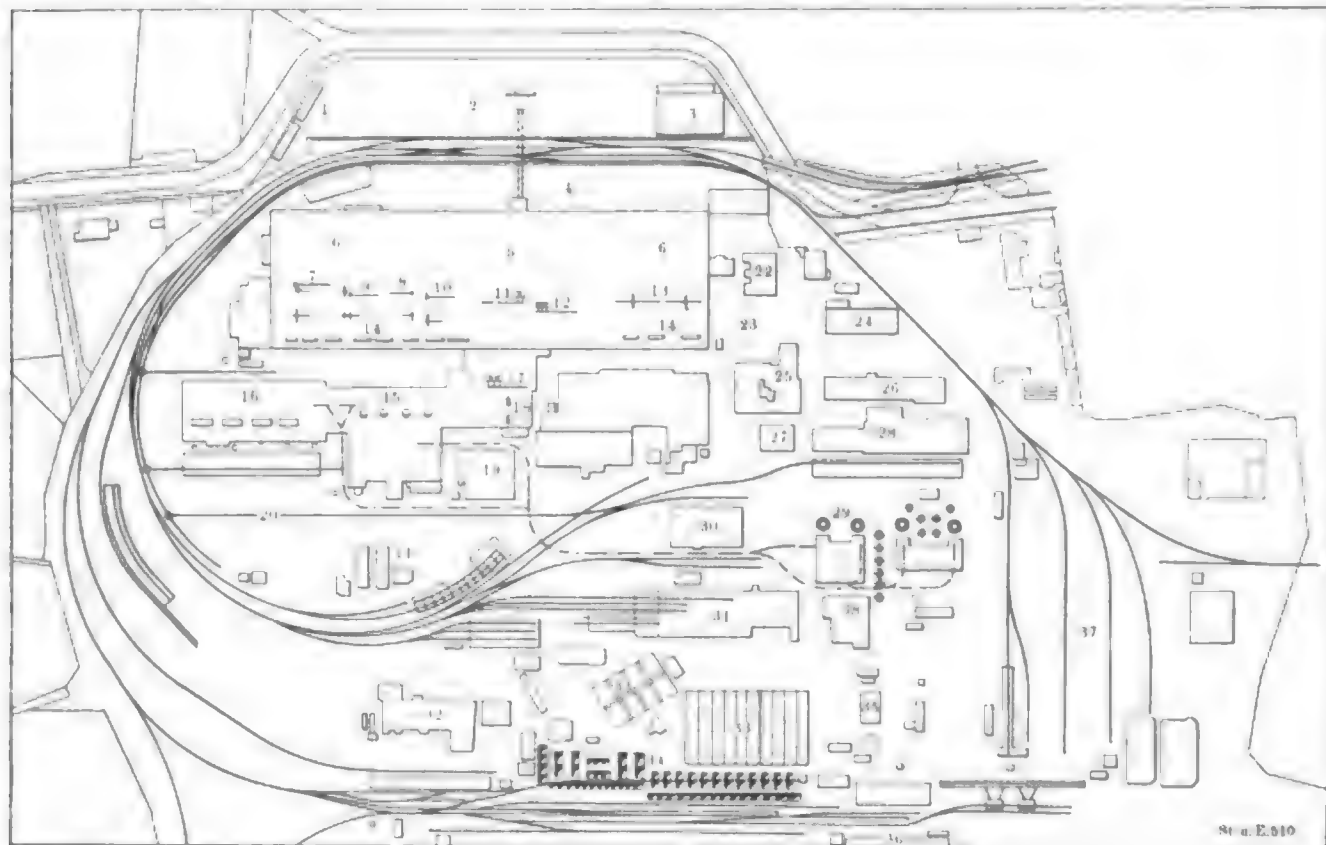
Lageplan des Eisenwerkes Kladno.
